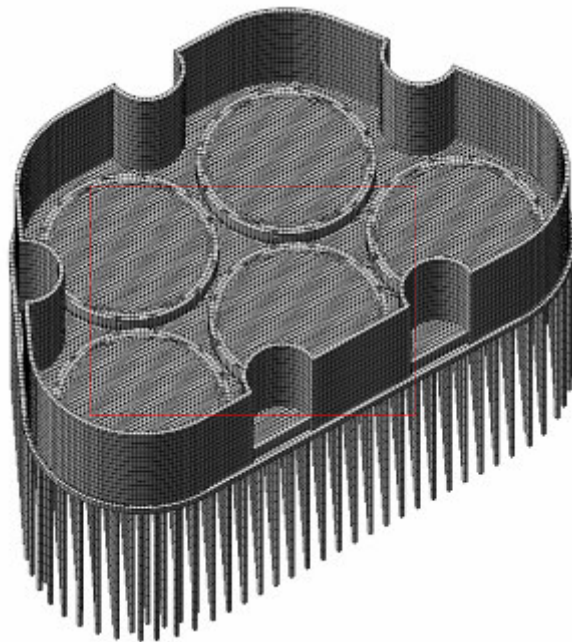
Общий вид монолитной железобетонной чаши и фундамента
